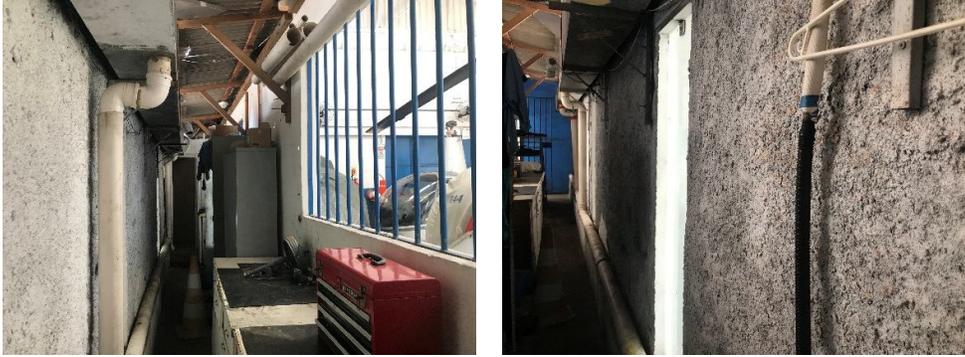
, 09, 10 e 11: Interior do Hangar 73.
